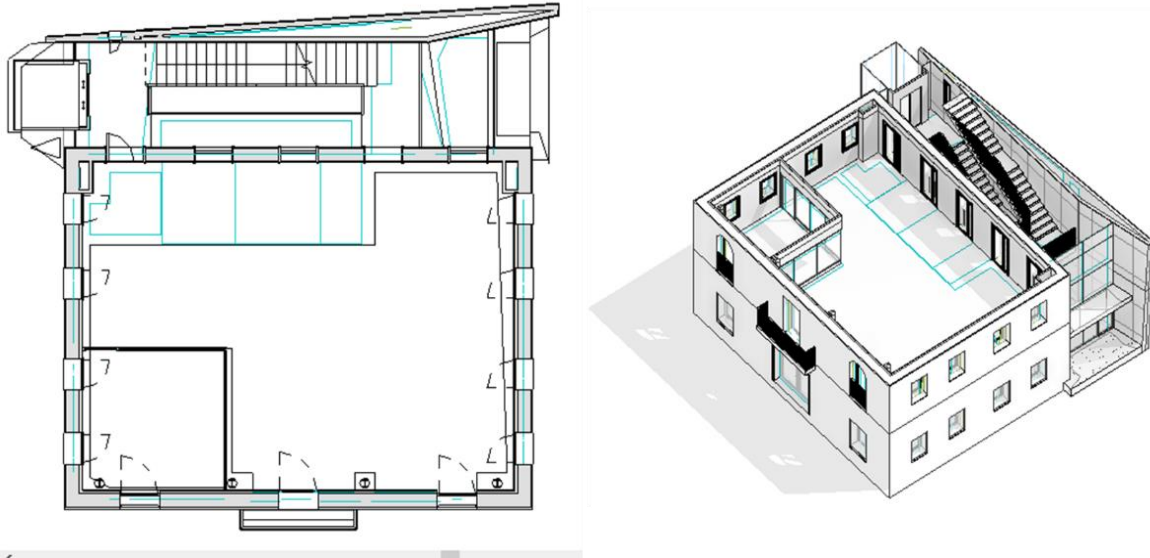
Planta 1º- Edificio de la sede UOC en el Baix Llobregat
